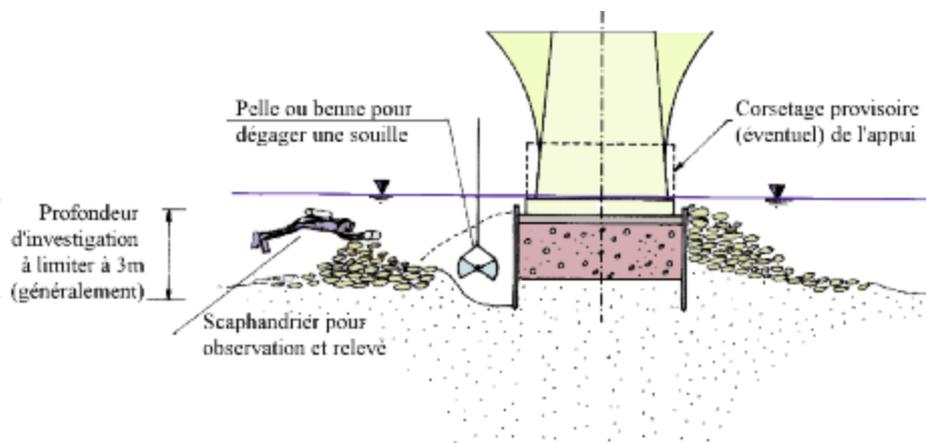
observations sur la base d'un appui par ouverture d'une fouille
